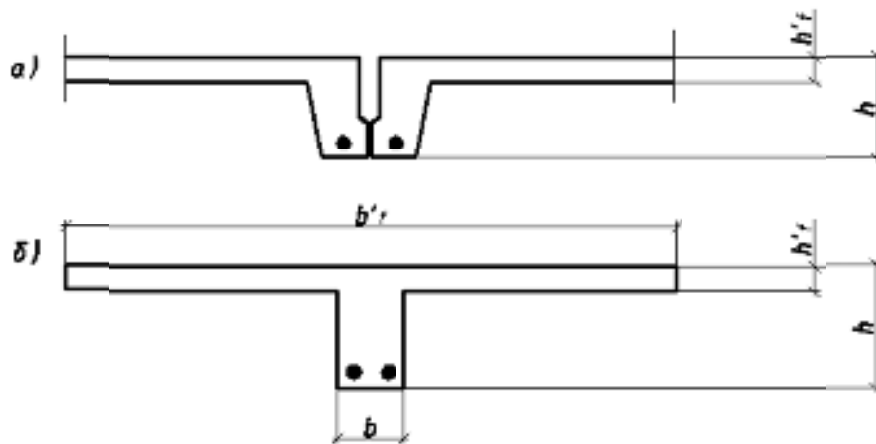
Фактическое (а) и эквивалентное (б) сечения ребристых плит перекрытий и покрытий
